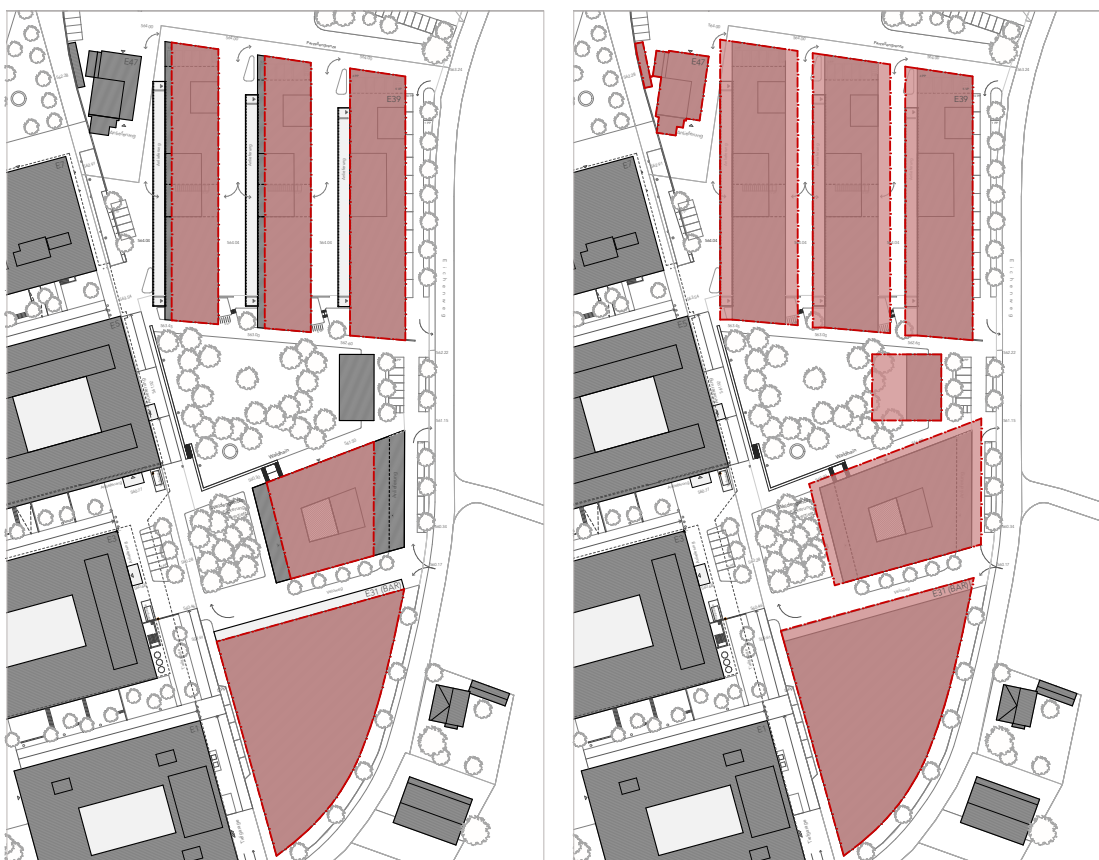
Situationsplan mit minimaler anrechenbarer Gebäudefläche in rot
